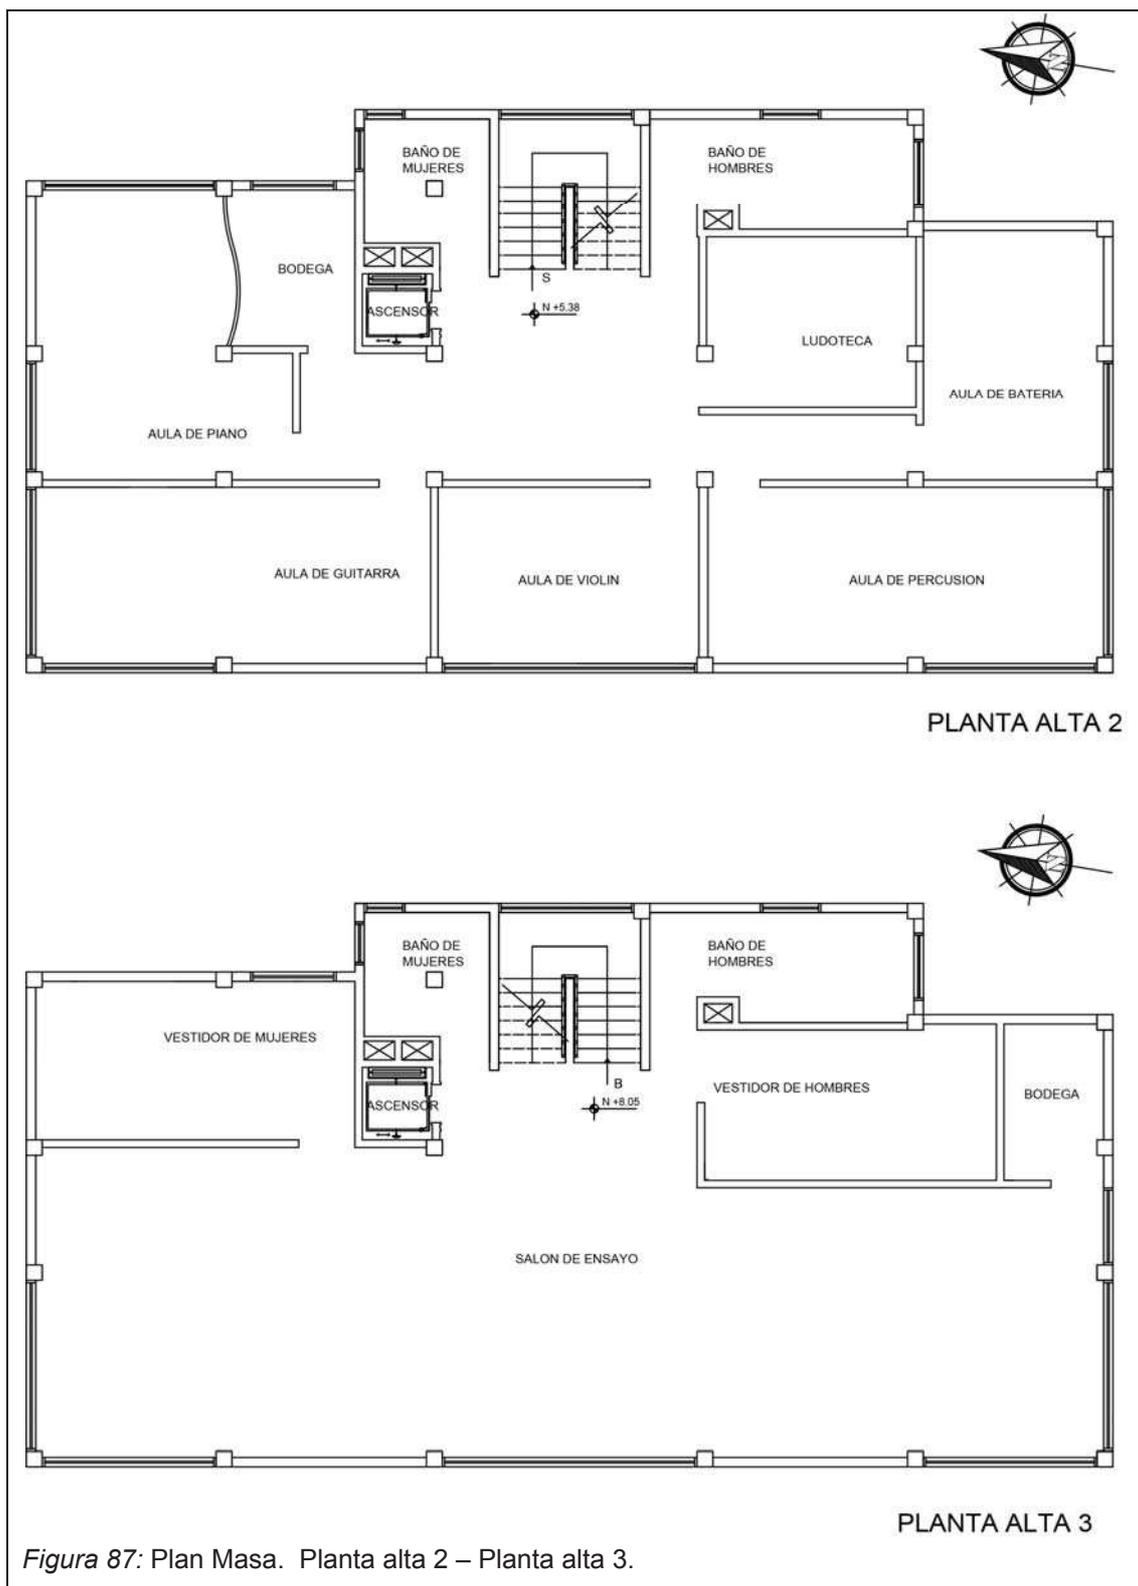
Plan Masa. Planta alta 2 – Planta alta 3.
